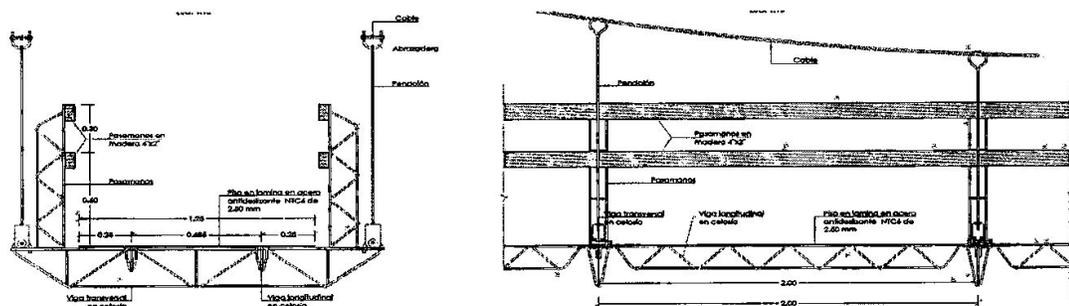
Detalle vigas en acero estructural, tablero y pasamanos del puente colgante peatonal – Quebrada San Francisco¹².
